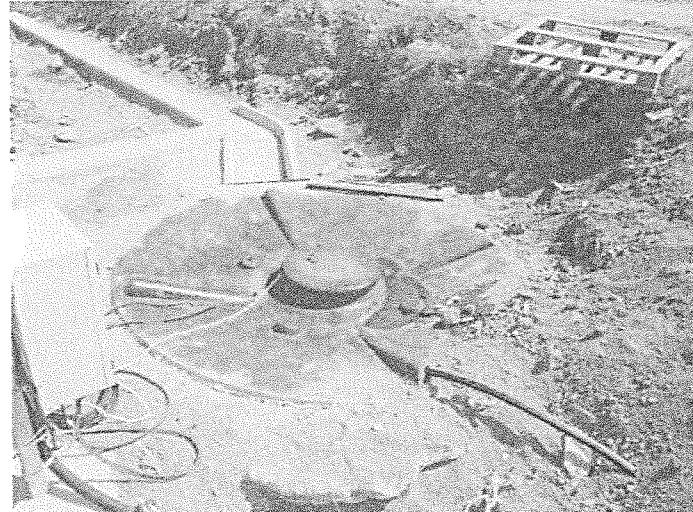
installation de la cuve et du tableau électrique sur plateforme des balayeuses
